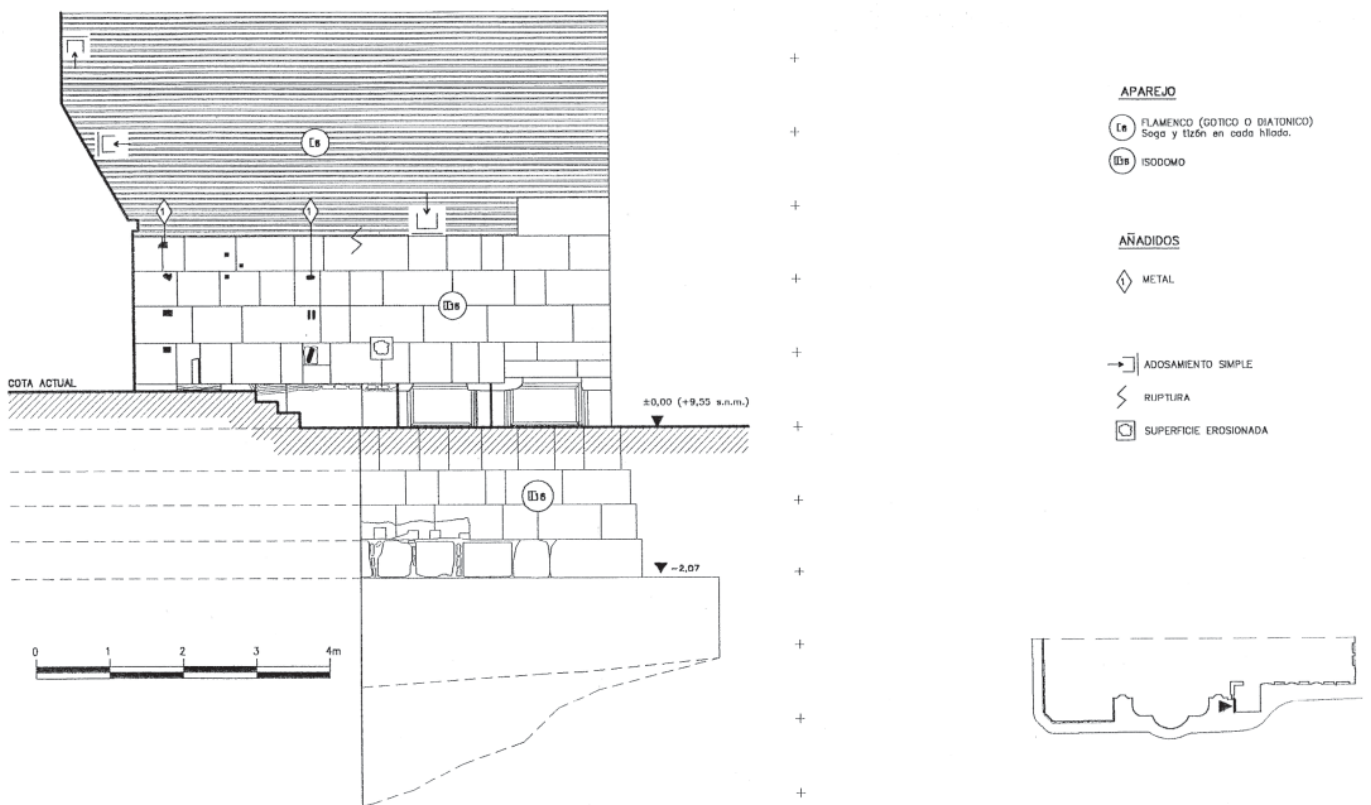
Cara Sur de la Giralda. Alzado tipológico-estructural.
